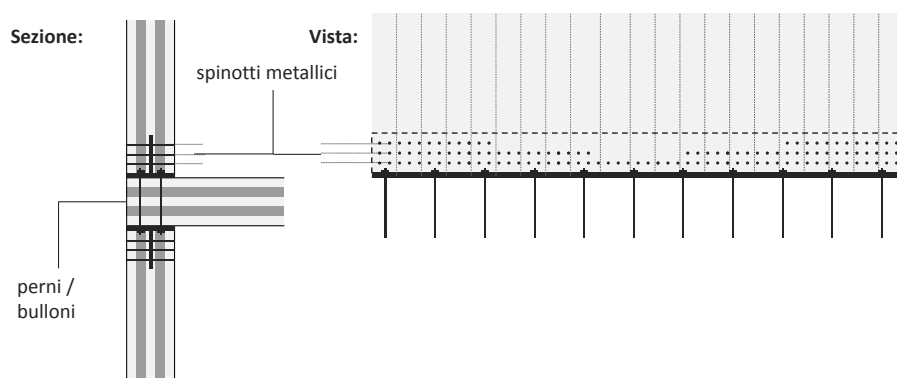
collegamento per prestazioni elevate parete-soletta-parete XLAM con staffe metalliche a T, perni e spinotti
